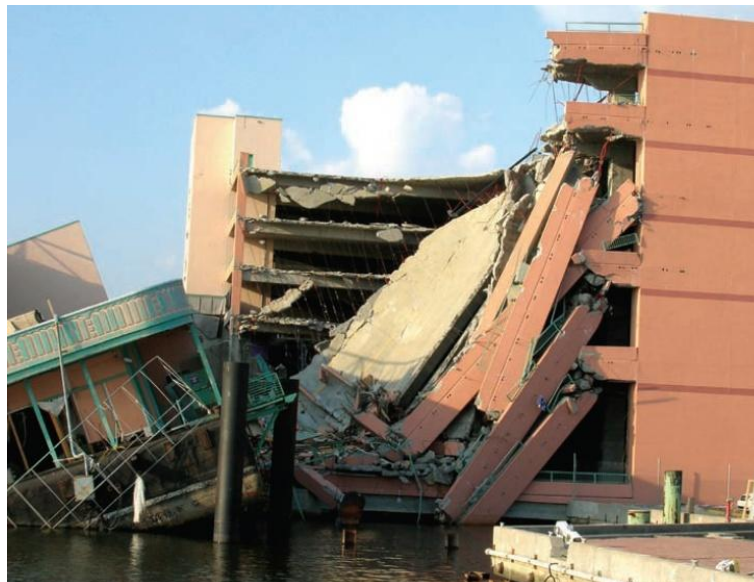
Effondrement progressif des étages supérieurs d'un garage de stationnement en raison des dommages subis sur les poteaux du niveau inférieur suite à l'impact d'un casino voisin installé sur une barge (Saatcioglu et al., 2005).
